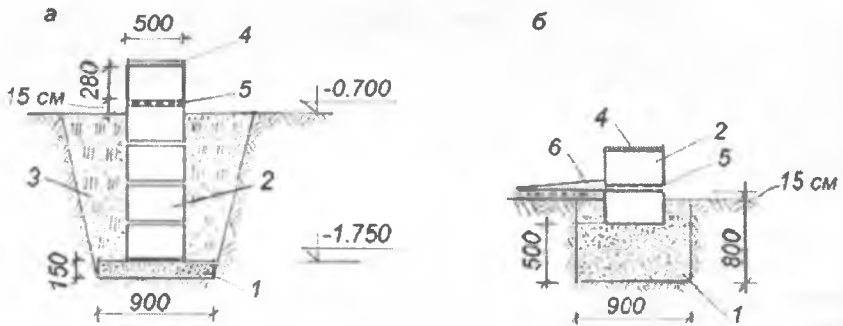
Схема устрою збірного стовбчастого фундаменту:
